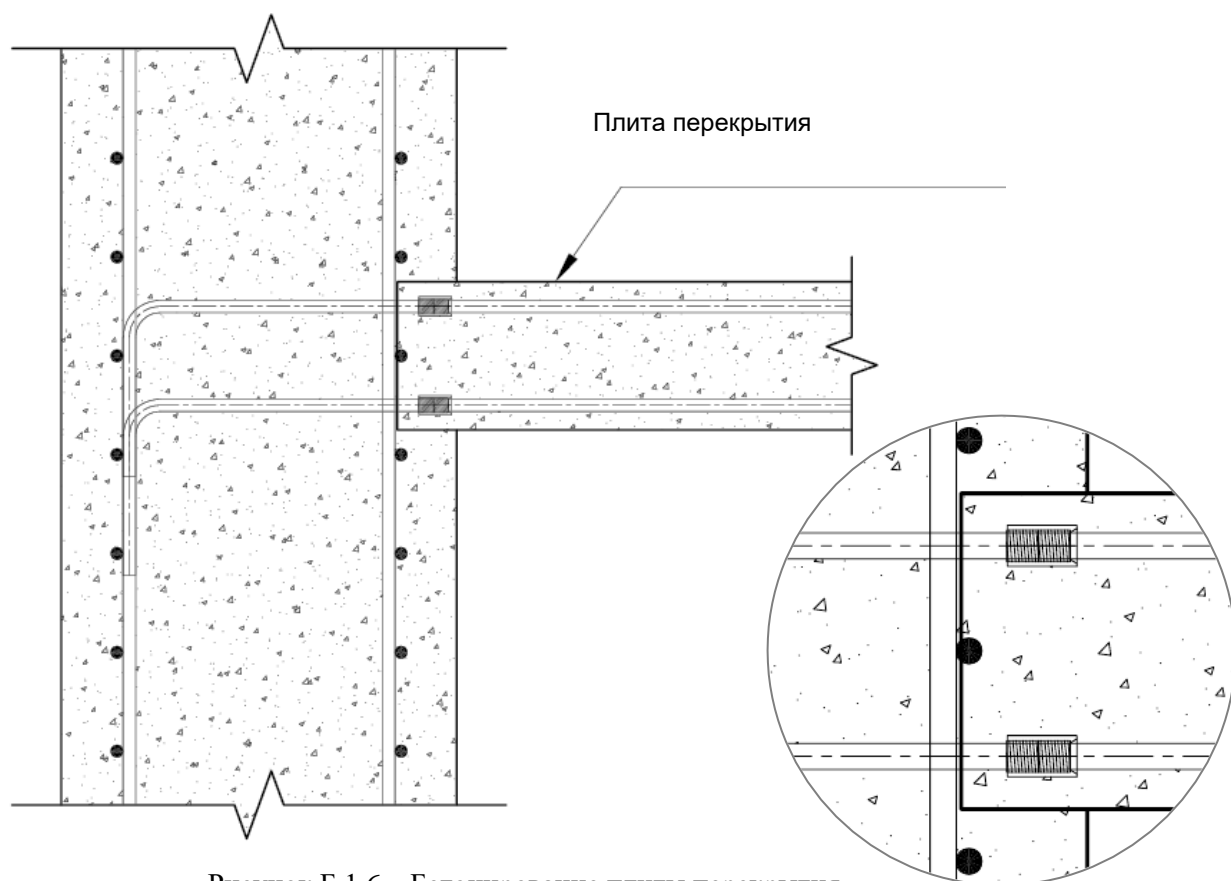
Бетонирование плиты перекрытия
